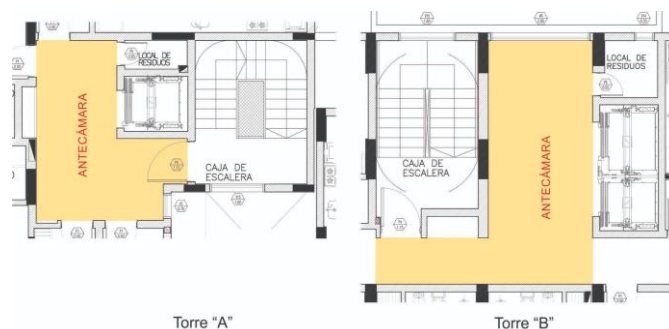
Antecámaras escaleras planta tipo
